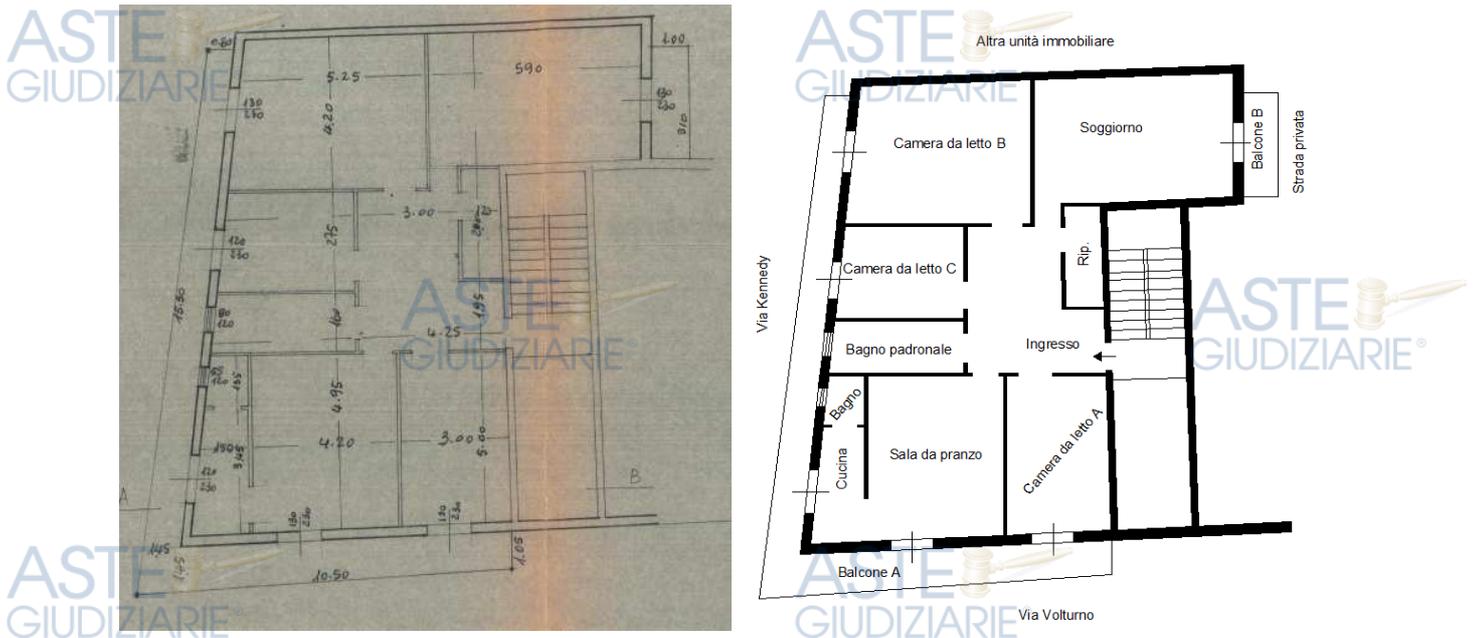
Confronto tra stato attuale e progetto da permesso di costruire in sanatoria
